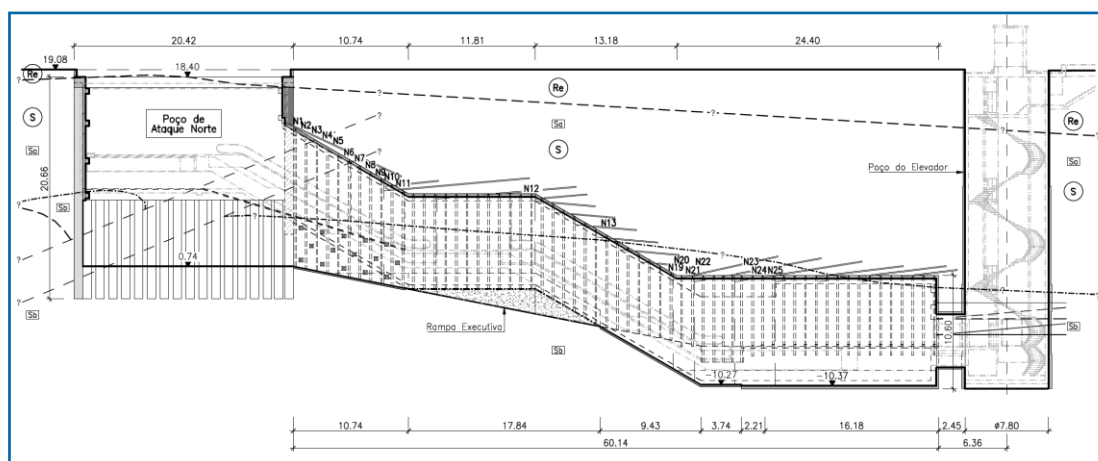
Corte longitudinal da solução de escavação ao longo do alinhamento do acesso Norte e secção tipo do túnel descendente
